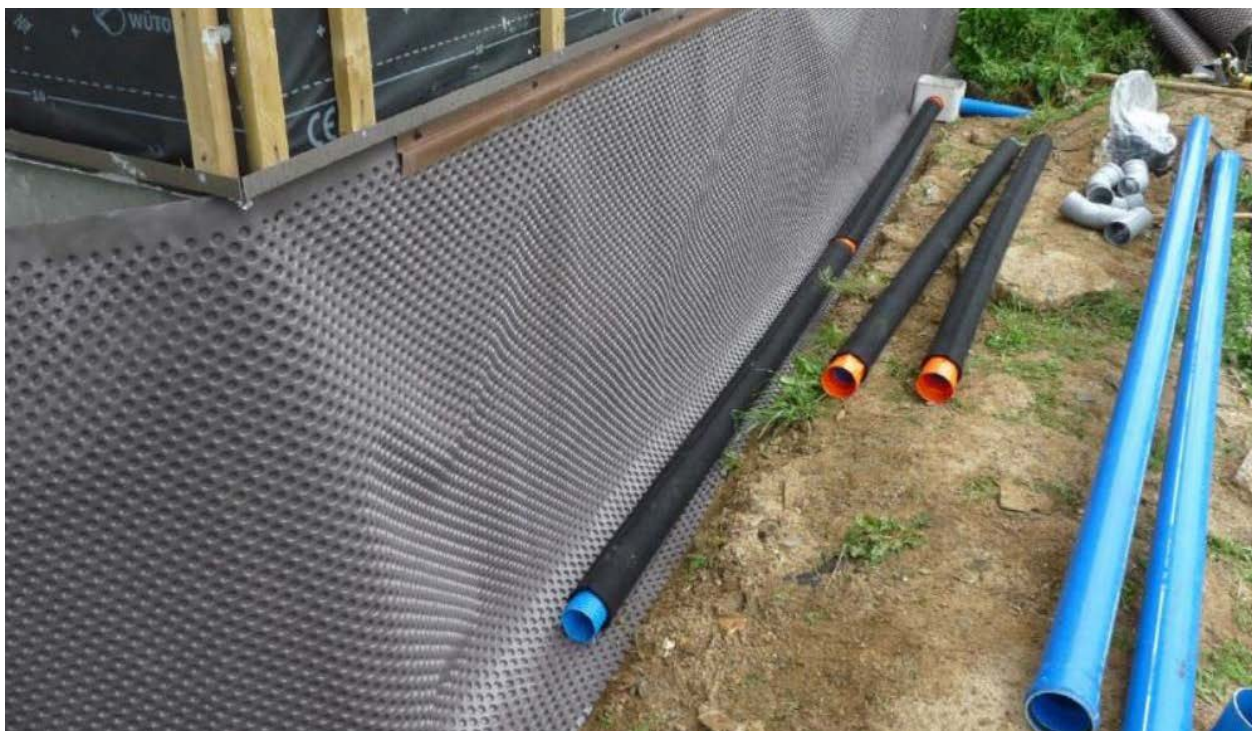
POSE DU DRAIN BATIFIBRE® SUR L'ÉTANCHÉITÉ GAUFRÉE
